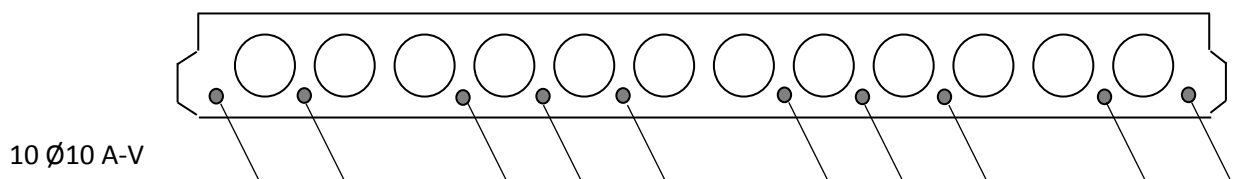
Размещение продольной напрягаемой арматуры в поперечном сечении плиты
